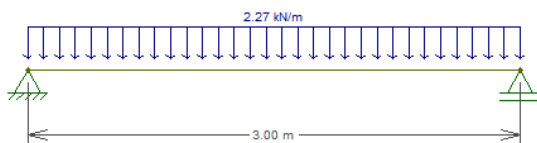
Modelo estrutural dos caibros do primeiro pavimento. Fonte: do autor
